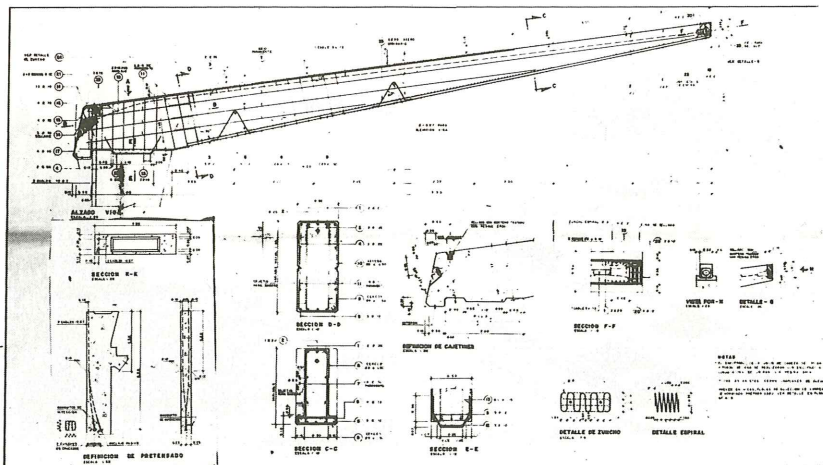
Pretensado de la ménsula y de la unión viga-pantalla.
